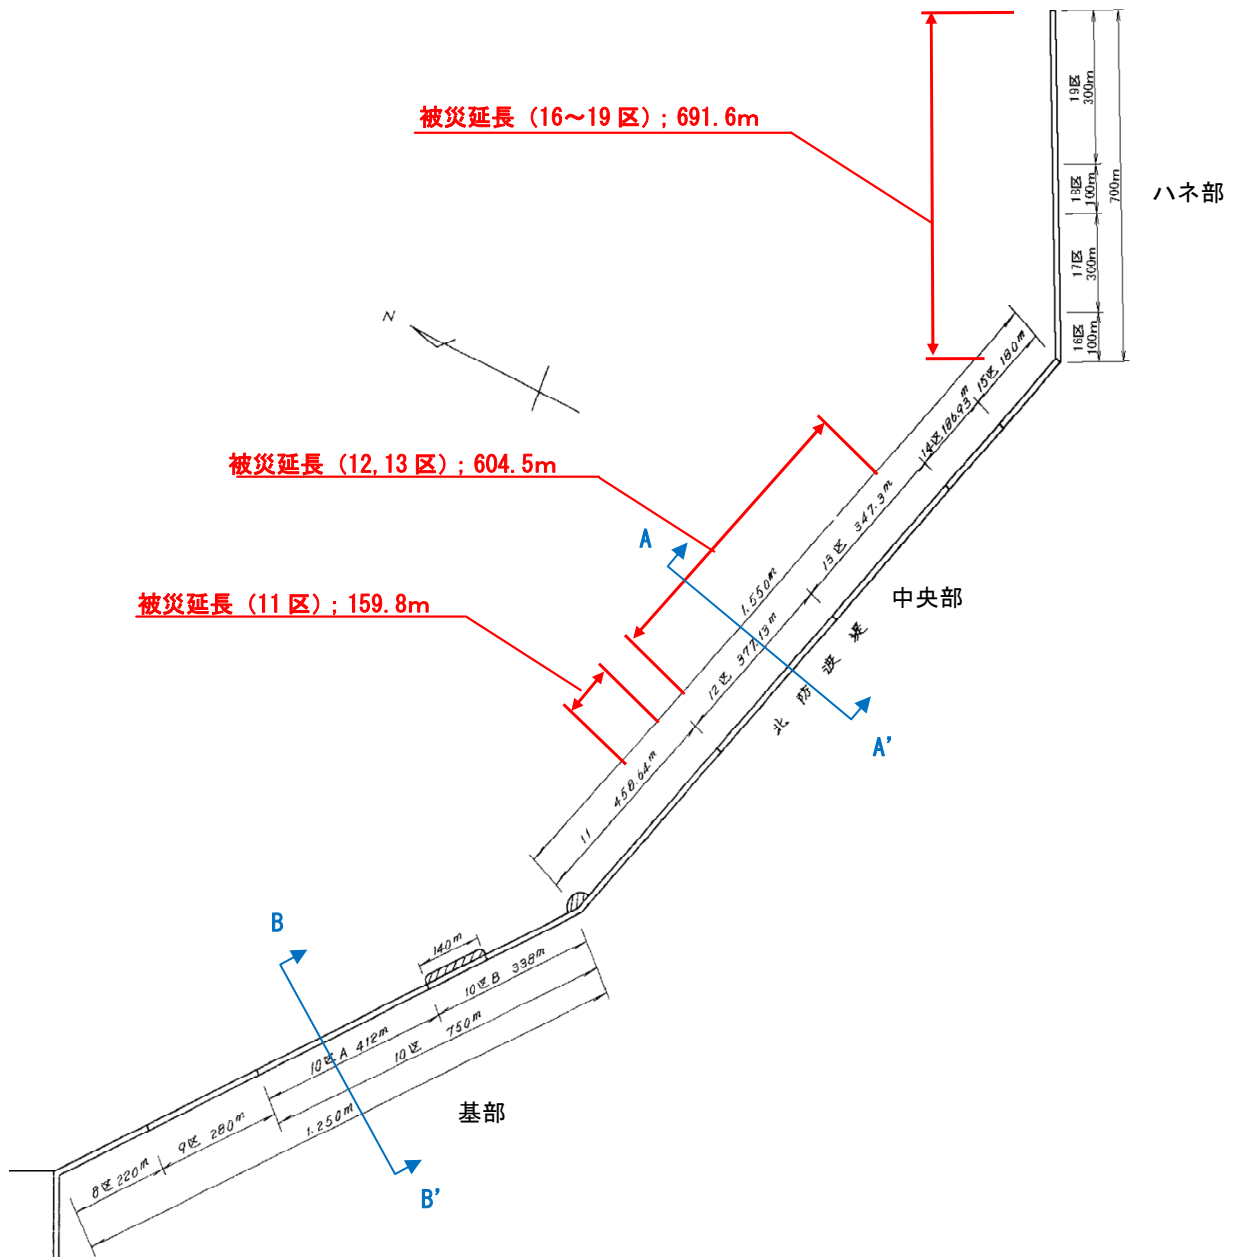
No.1 八太郎地区_北防波堤の平面図（被災前後）
